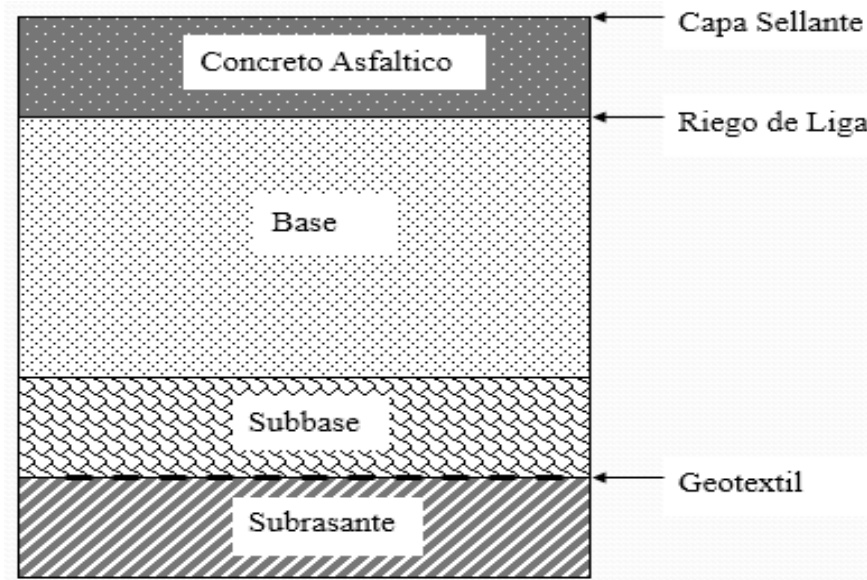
Fuente: Introducción a la Ingeniería de Pavimentos,
